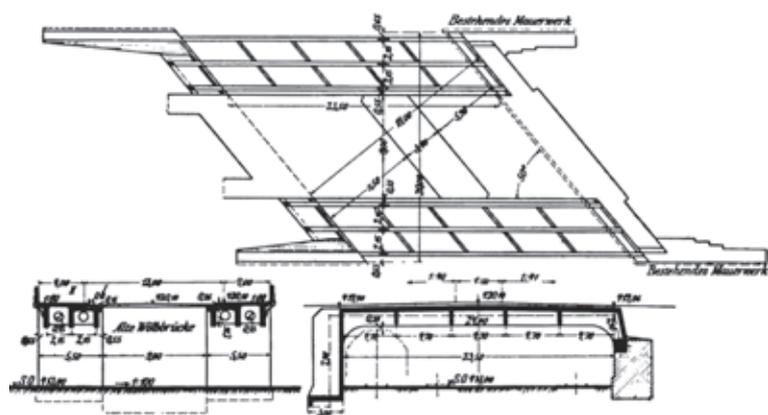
Brücke Pausaer Straße in Plauen/Sachsen – Grundriss und Schnitte [9]
